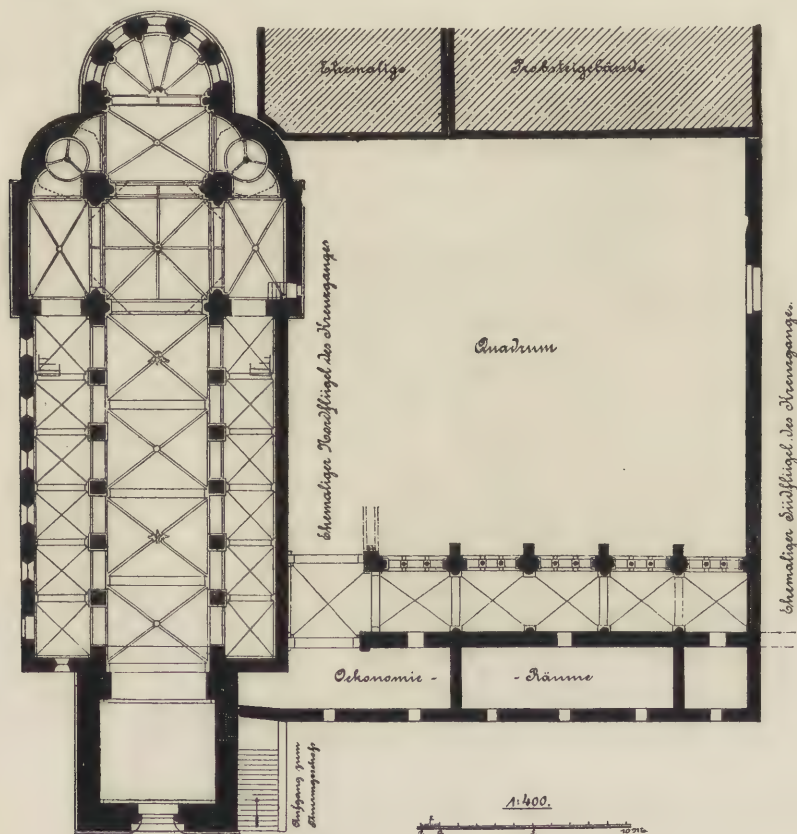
Grundriss von Kirche und Kreuzgang.
